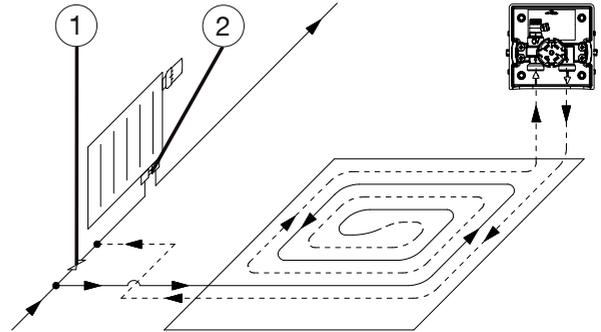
Anschluss mit Bypass-Ventil und Heizkörperverschraubung mit Bypass
